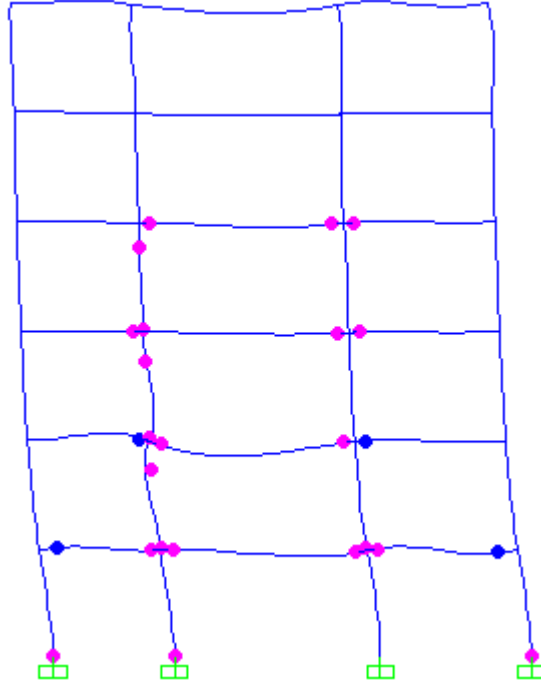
4 kat betonarme + 3 kat çelik rijit bağlantılı çerçevenin RSN57 kaydı altında hasar dağılımı
